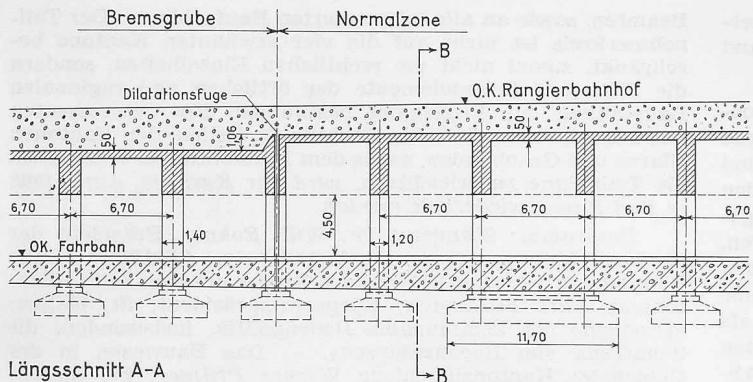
Autobahn-Galerie Schweizerhalle, Schnitte 1:500. Man beachte die aussergewöhnlichen Abmessungen der Eisenbetonkonstruktion
